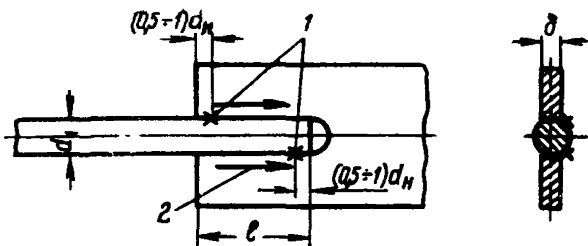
Места прихваток и направления наплавки швов в тавровых (в плоскости) соединениях стержней с плоскими элементами проката с прорезью
